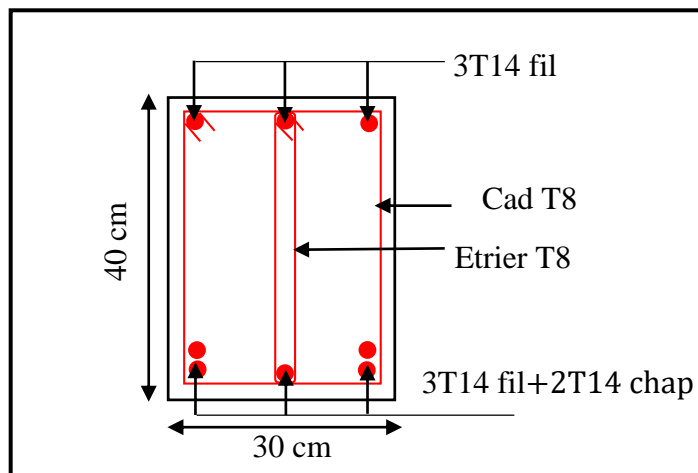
exemple schéma de ferrailage d'une poutre
